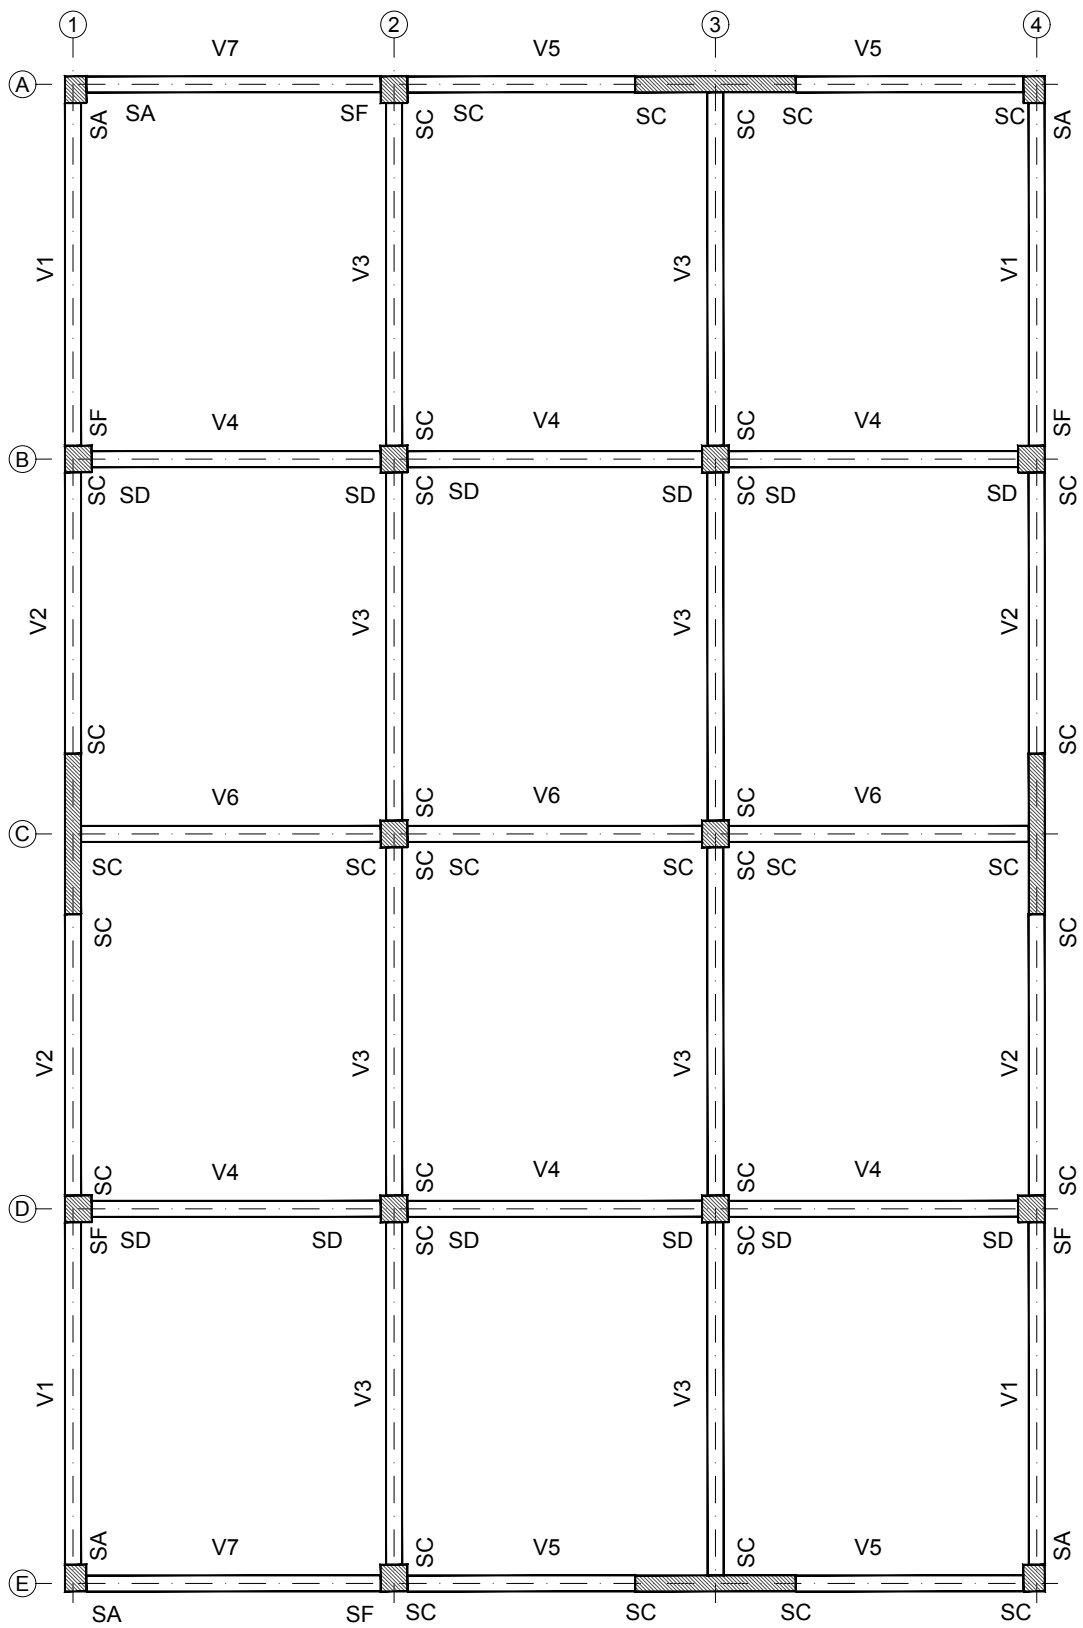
Vigas e secções de armadura das vigas – Pisos 2 a 8.
